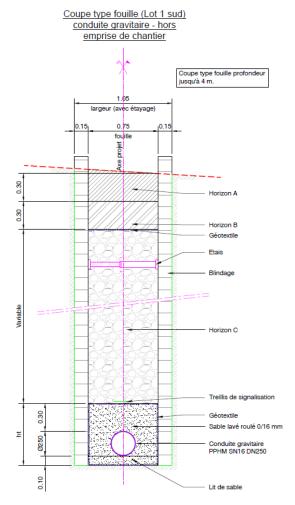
Coupe-type conduite gravitaire hors emprise de chaussée
